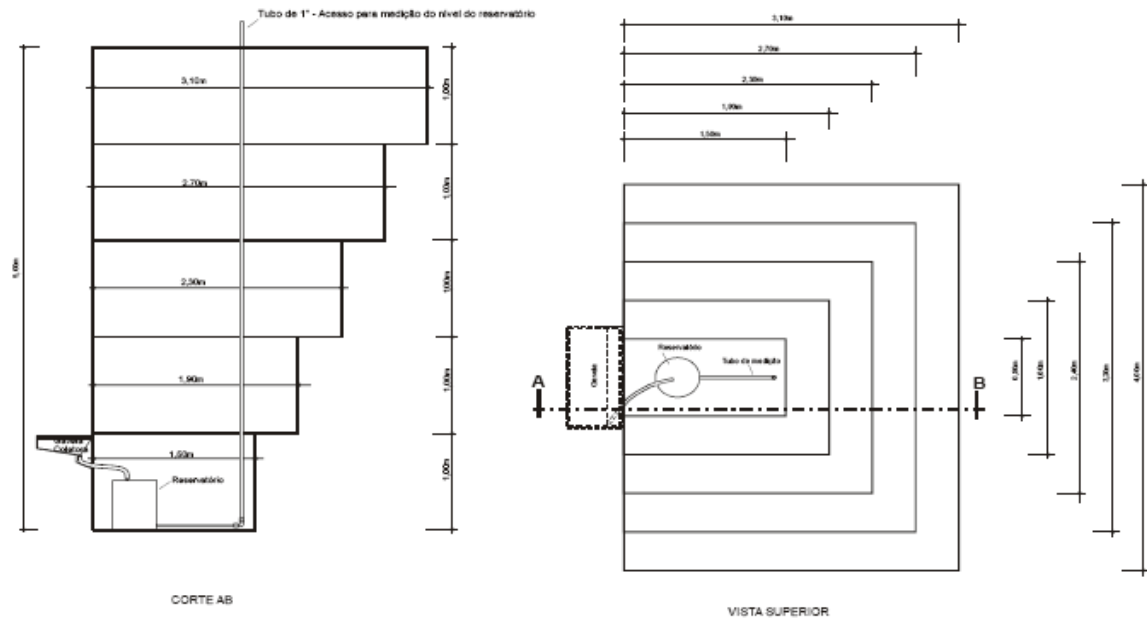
Projeto de lisímetro de gaveta – escavação e instalação
